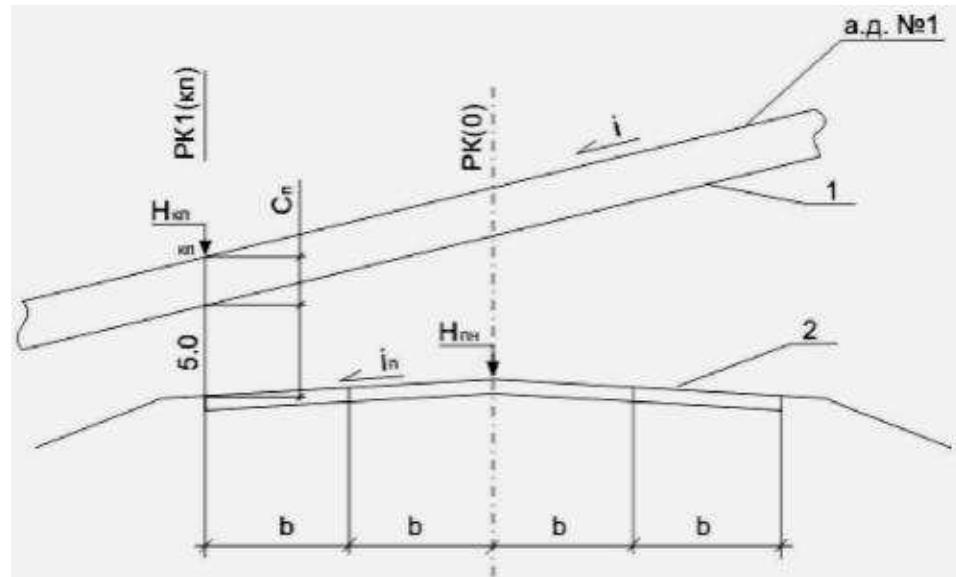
Схема определения контрольной отметки на путепроводе
